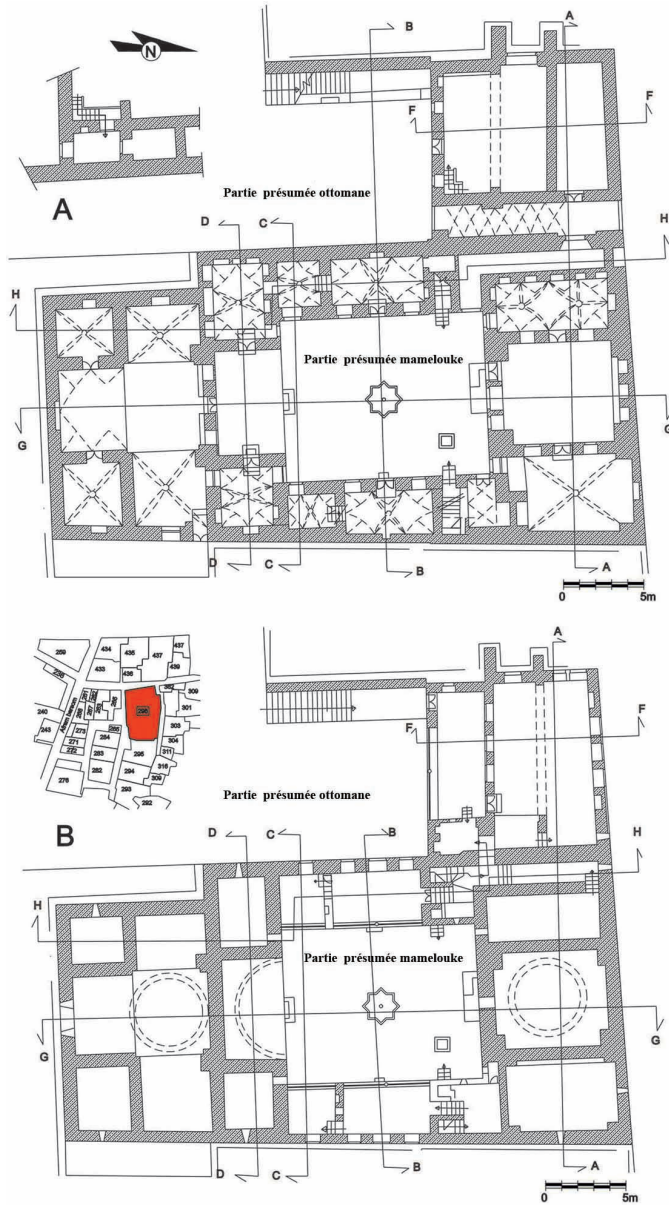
La demeure al-Zahrāwī : A. Plan actuel du rez-de-chaussée de l'ensemble de la demeure ; B. Plan du premier étage (Ġ. Ṭaṭṭaq, 'I. al-Maṣri ; I. Fayyad).
